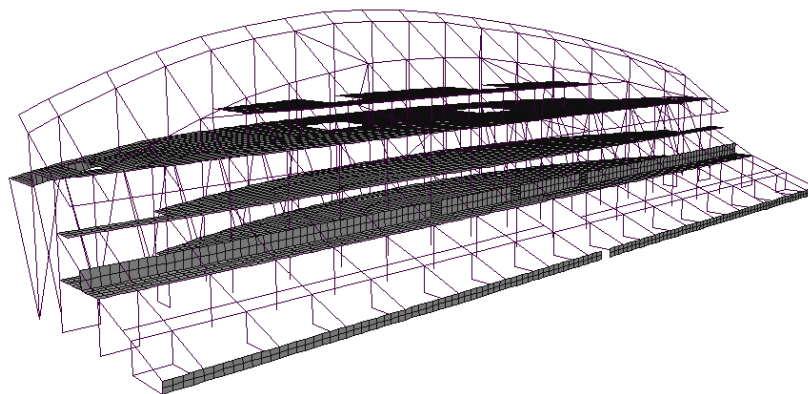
Modelo estrutural adoptado para a Bancada Poente
